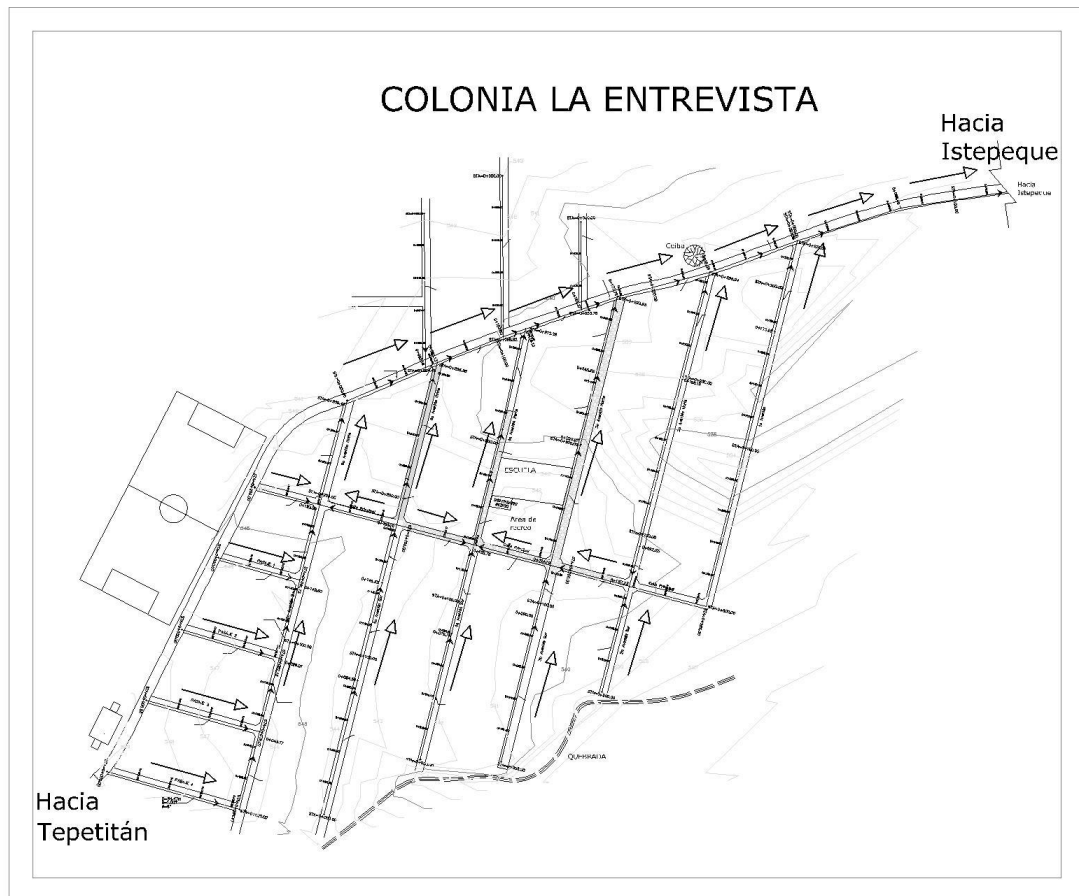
Alcantarillado sanitario en colonia La Entrevista.
